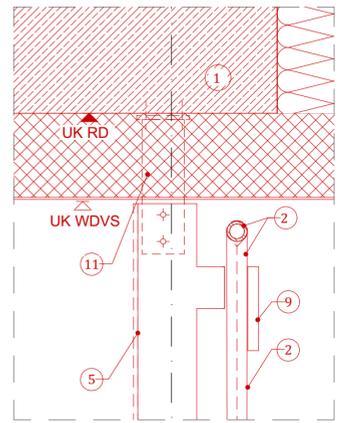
Fusspunkte Horizontalschnitt, M 1:10
